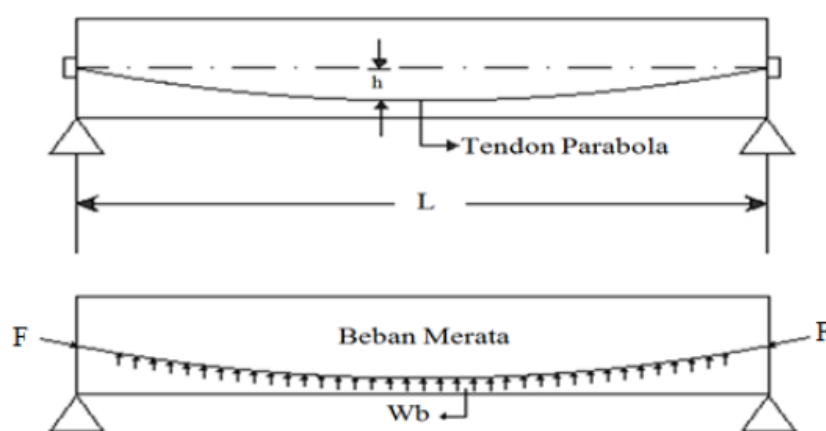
Balok Beton Menggunakan Baja Mutu Tinggi
